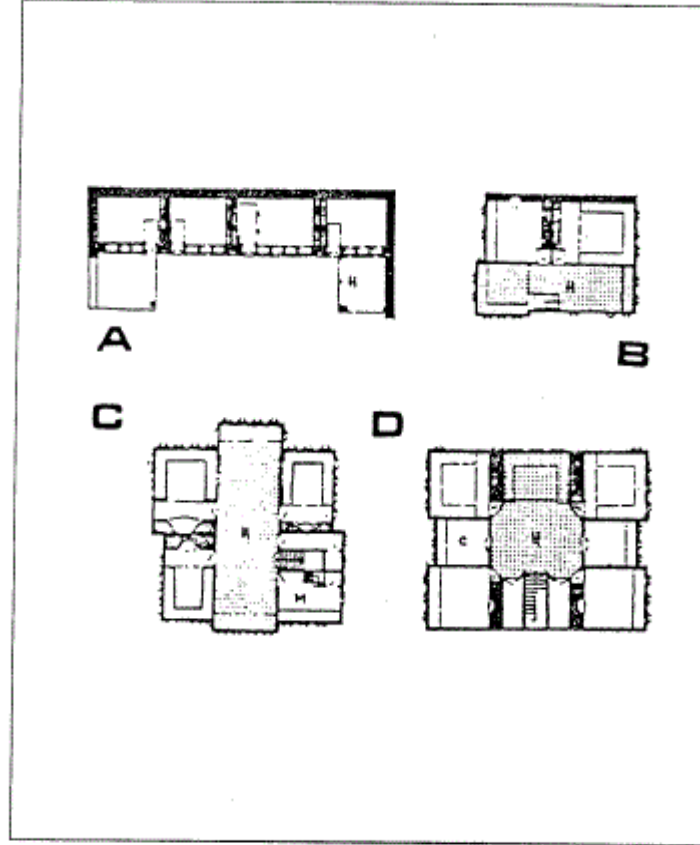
مكرر) مسقط أفقي للطابق الأرضي للمحرم لك بطوب قابى سراى
